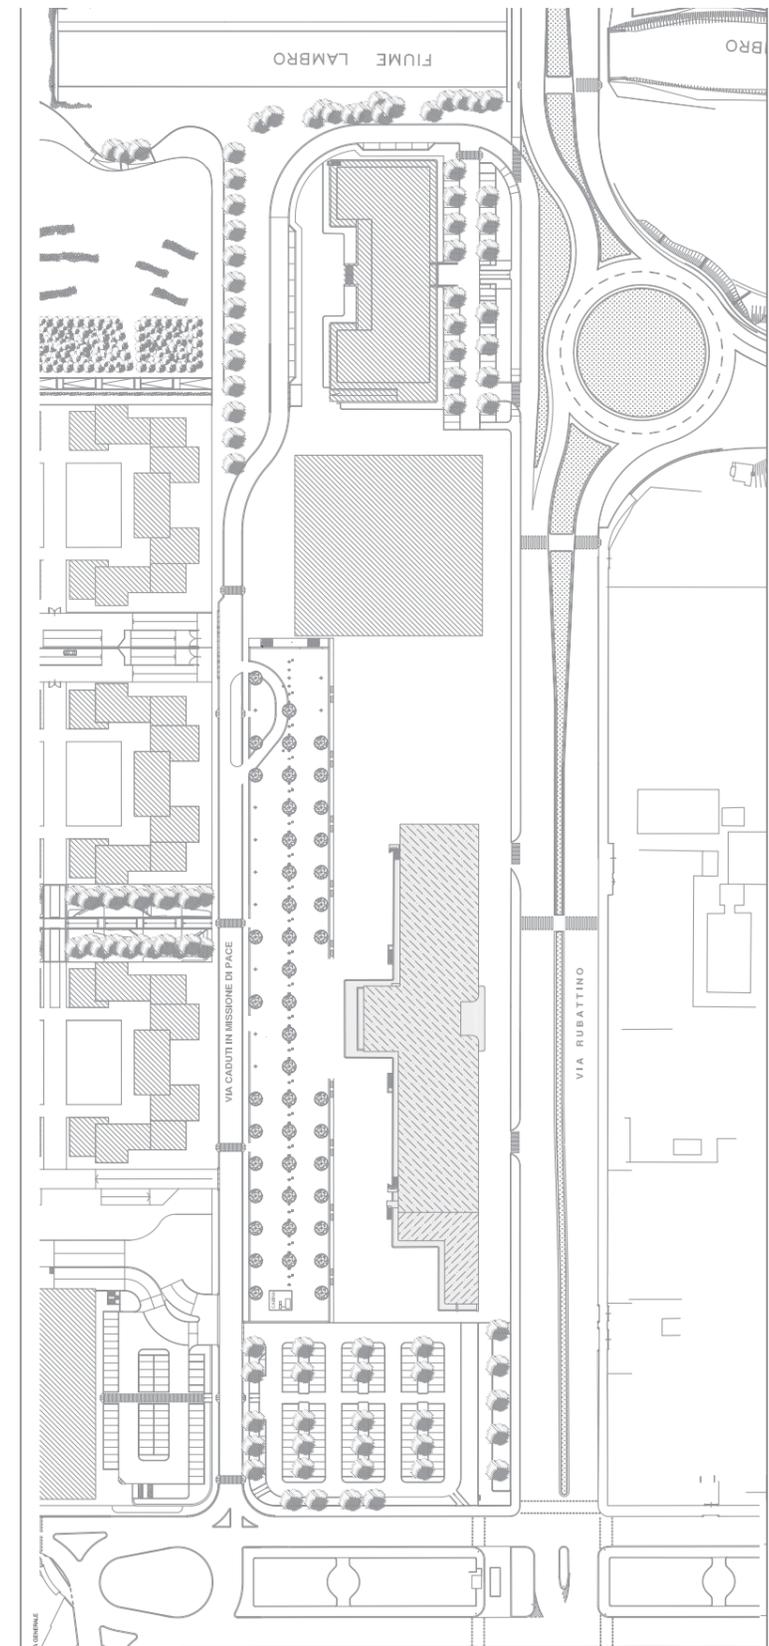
| “Stato di fatto - Planimetria generale“, 2011 | fonte: Arch. Marina Basso
